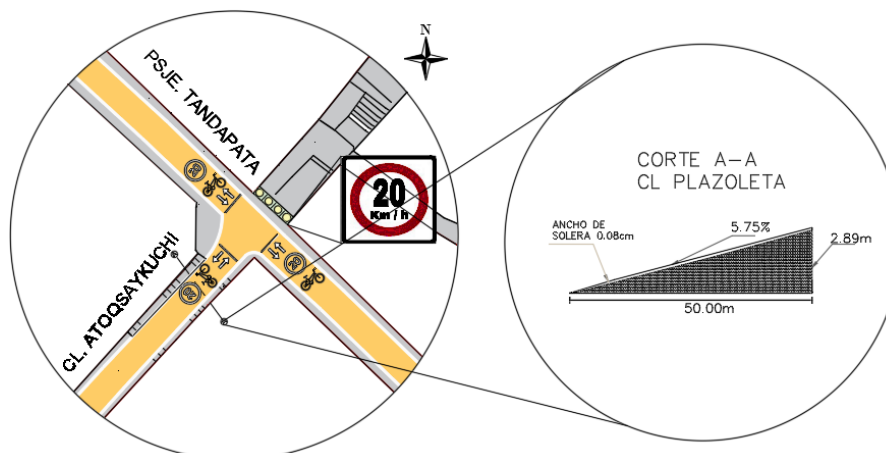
Propuesta en planta de calle Atoqsaykuchi con Tandapata
